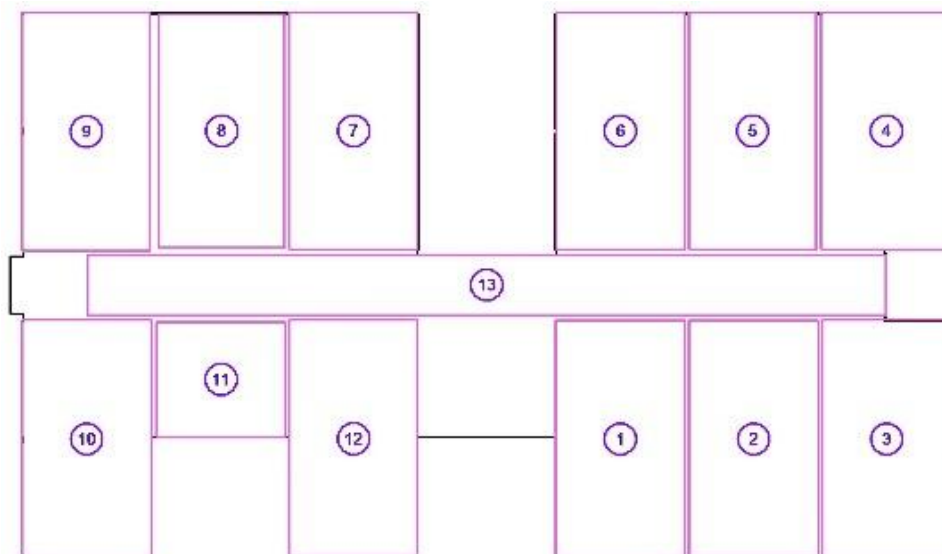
Planta de identificação das salas do primeiro andar do bloco Q
